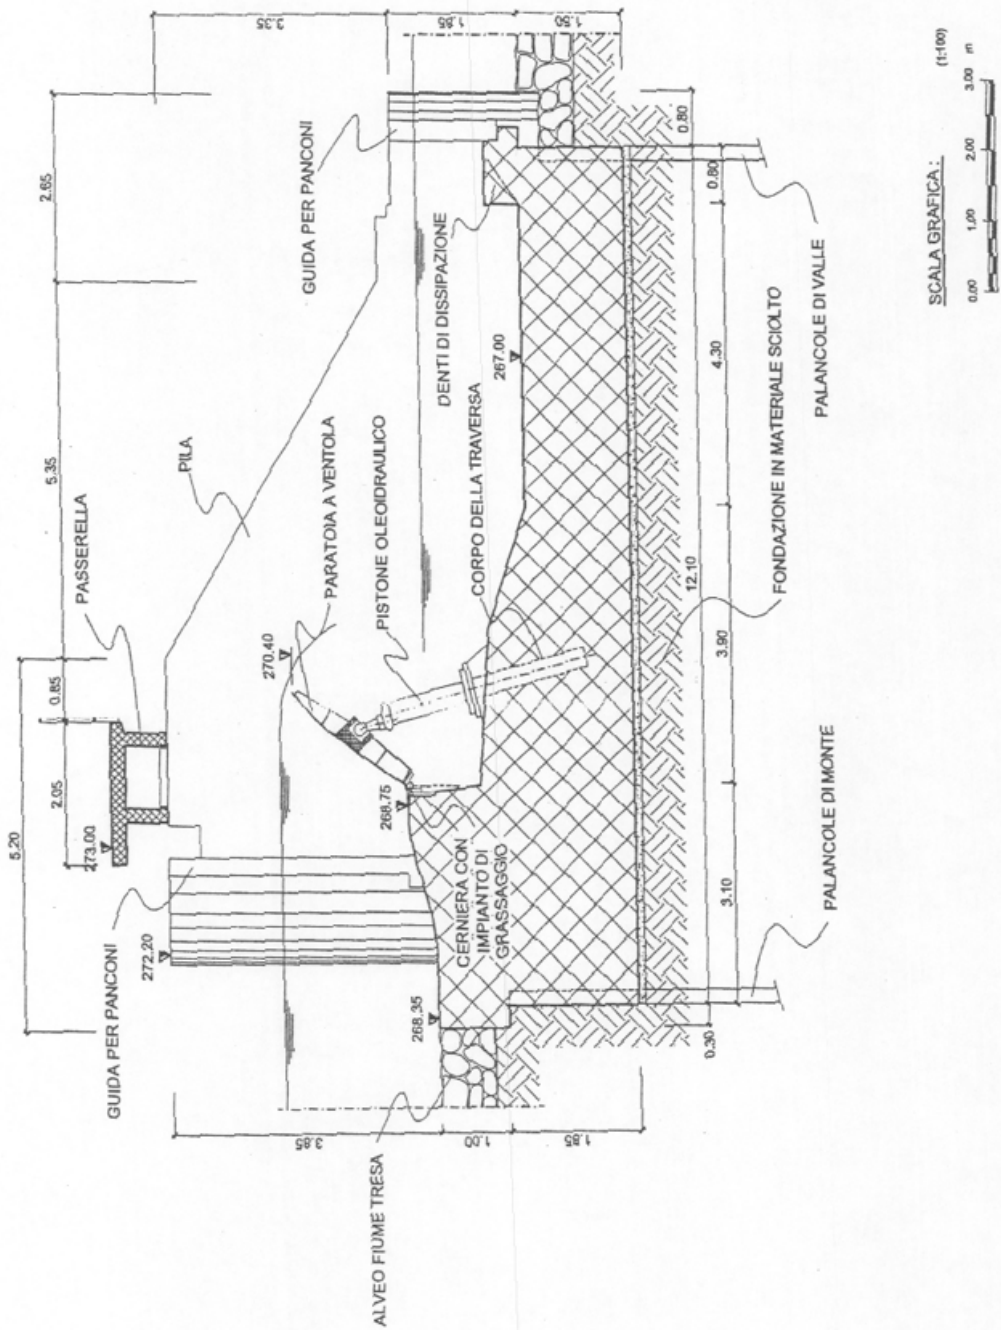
Sezione tipica della traversa mobile di Ponte Tresa.
